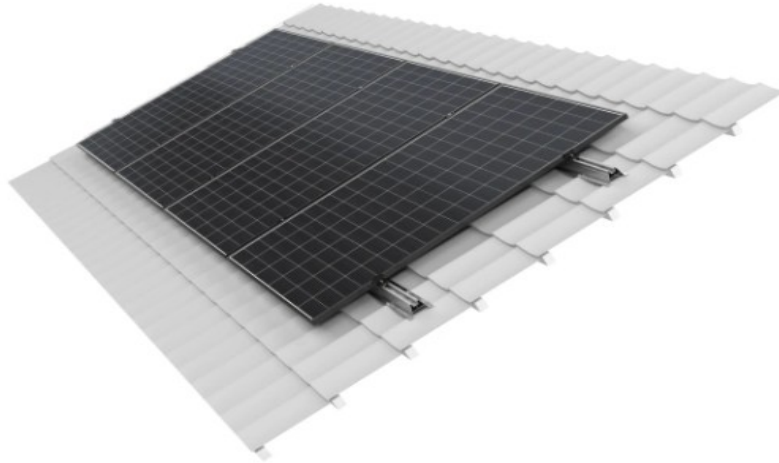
Konstrukcja wsporcza pod moduły.
